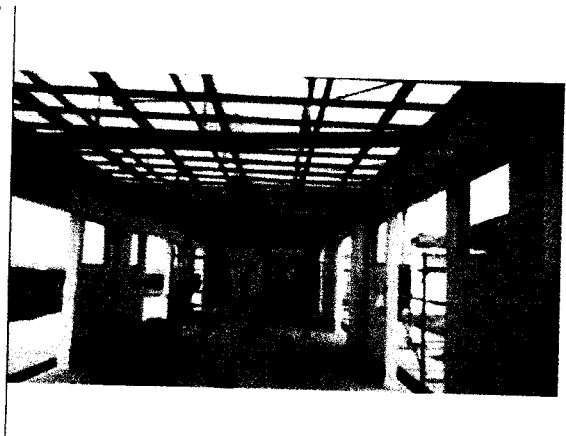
ESTRUCTURA DE FALSO CIELO RASO
